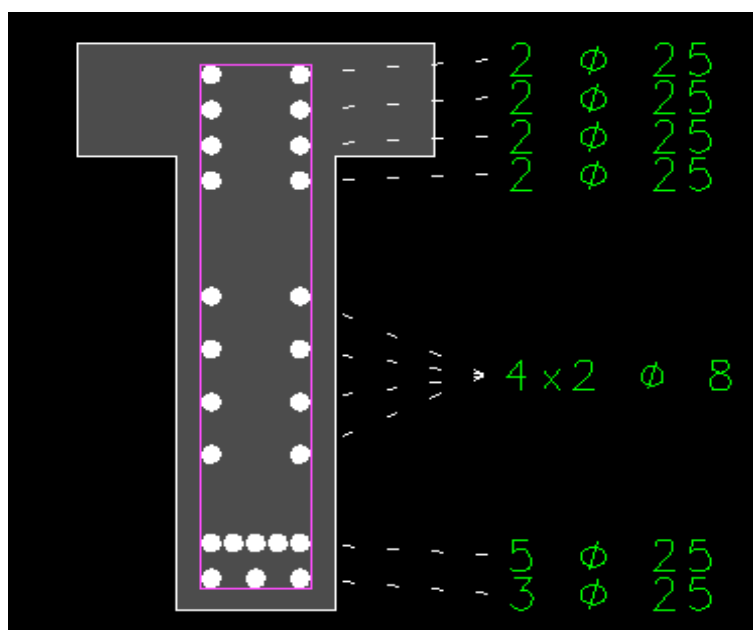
Seção da viga V9 (CAD/TQS)
